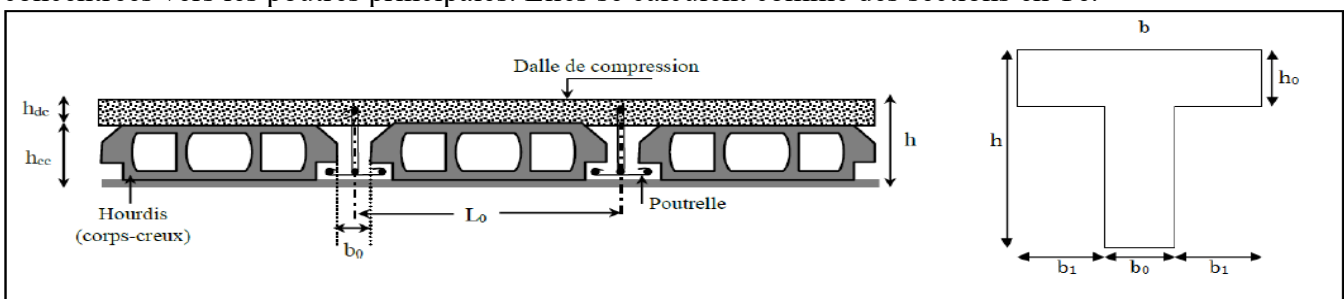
Coupe transversale d'un plancher à corps creux et d'une poutrelle.
